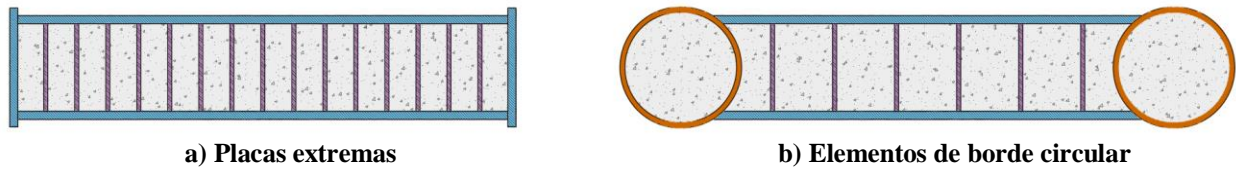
a - Muros de cortante planos en sección compuesta
